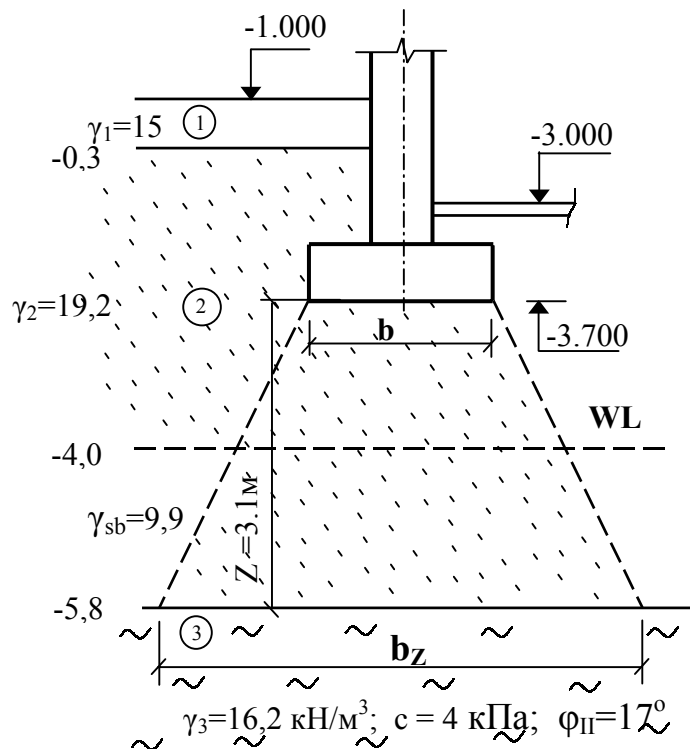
Схема розташування фундаменту у ґрунті
